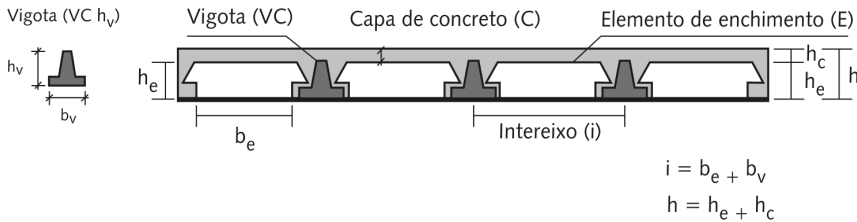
Lajes com vigotas de concreto armado (LCh)
